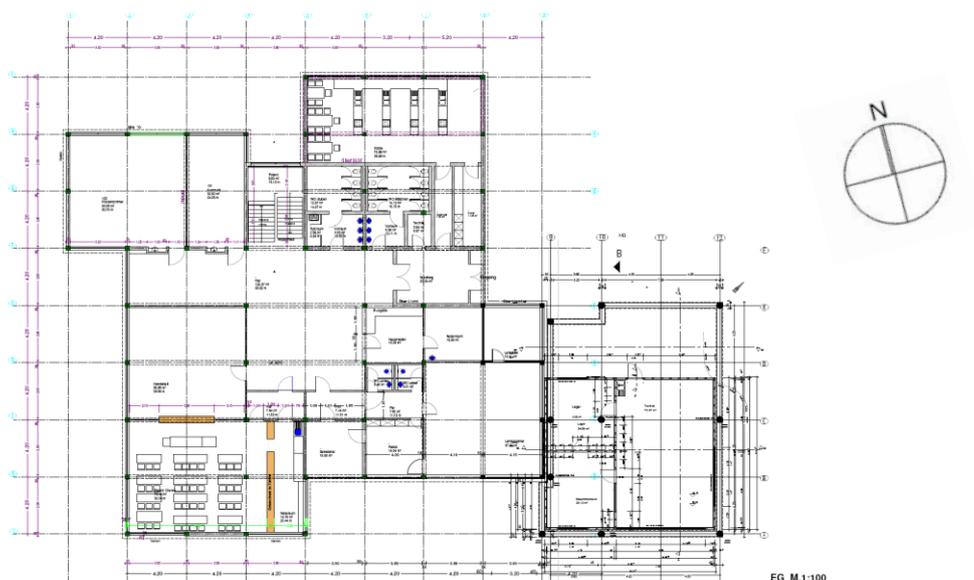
Grundriss des Erdgeschoß mit Verwaltungsbereich und Sondernutzung.
